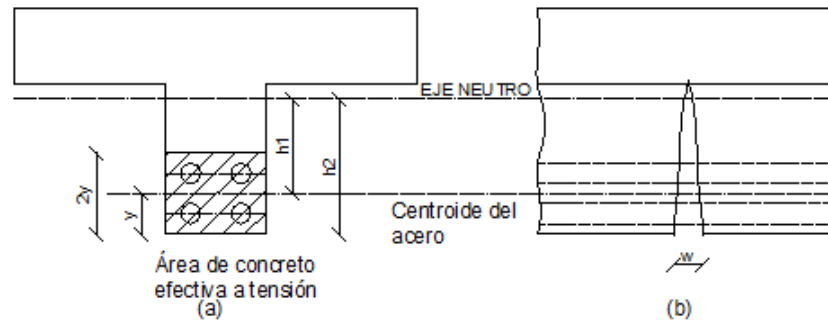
1 Parámetros geométricos para determinar el ancho máximo de la grieta w ; (a) sección de viga T; (b) agrietamiento en viga T
